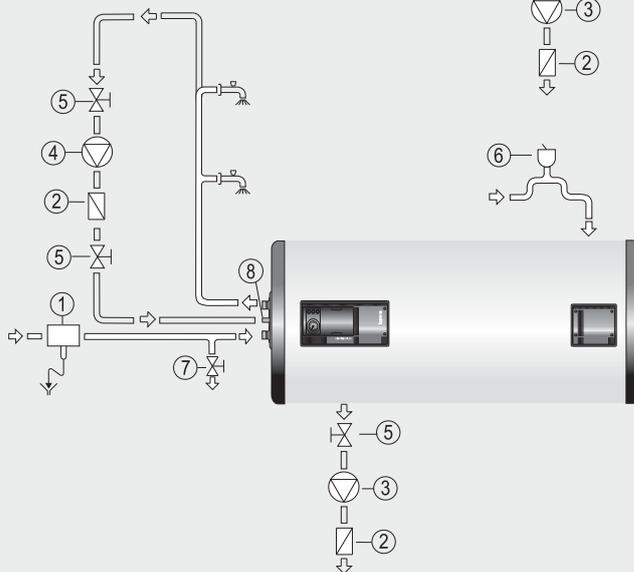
Horizontale Installation, Brauchwasseranschlüsse rechts
